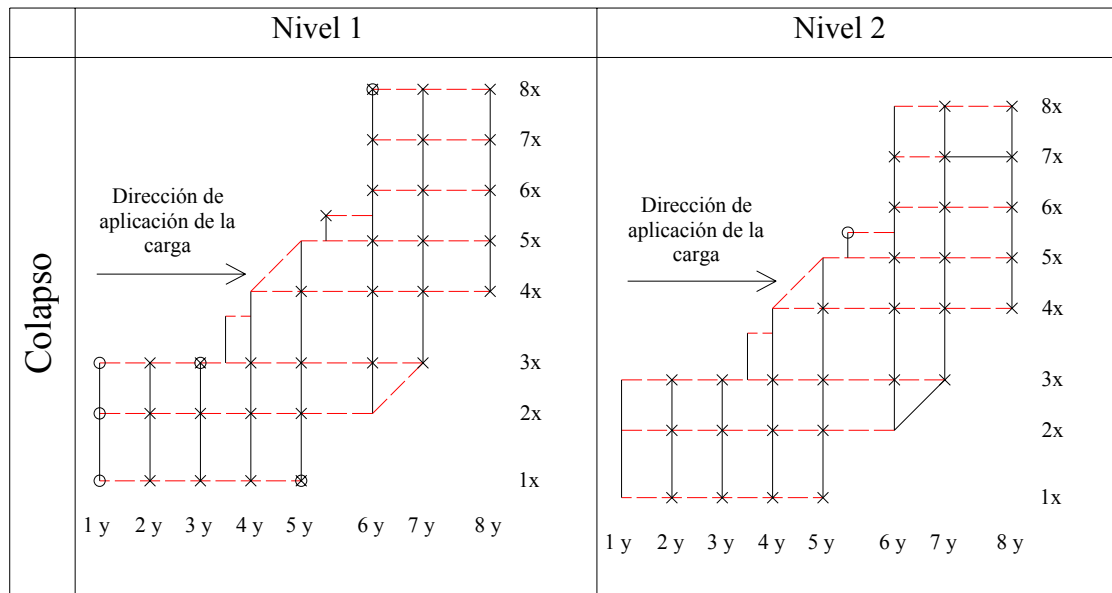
15 Vista en planta de los Nivel 1 y 2 para E.L. de CO.
